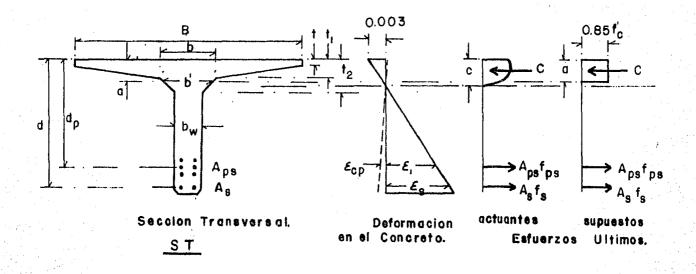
Viga de sección "T" (ST) y diagramas de deformación y esfuerzos bajo condiciones últimas de carga.
